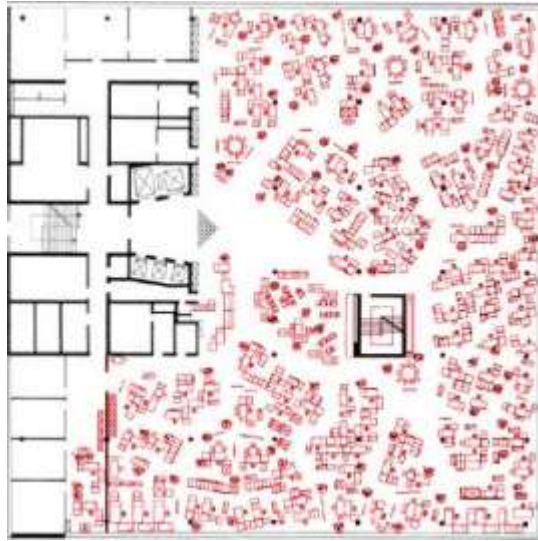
Chase-Manhattan Bankası Planı (1961, New York, Mim. Skidmore Owings and Merrill) (Url-11).
